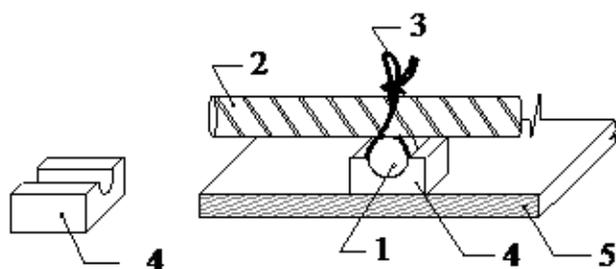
Установка фиксаторов арматуры: 1-продольной стержень; 2 – поперечный стержень; 3 – вязальная проволока; 4 – фиксатор; 5 - палуба
